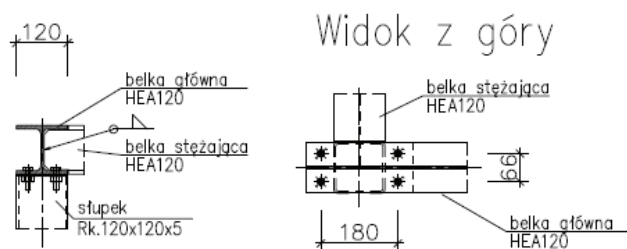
Detal połączenia słupka z belką konstrukcji wsporczej
